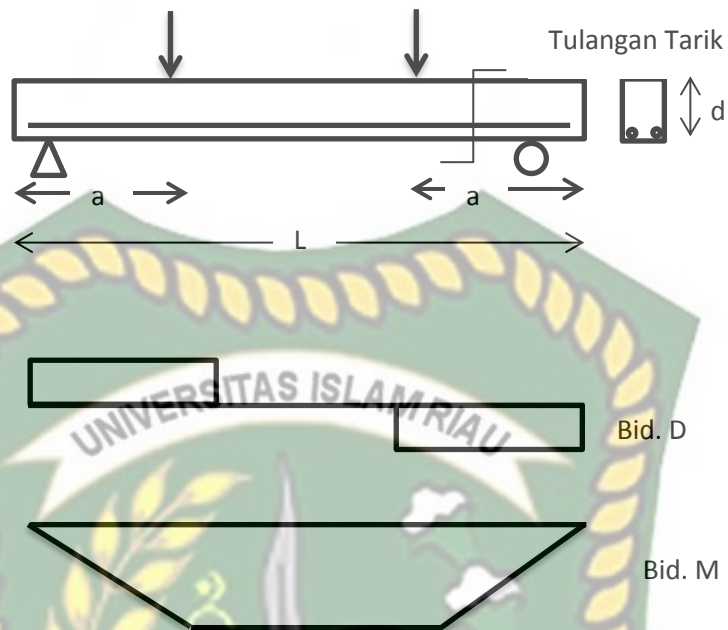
Elemen Balok Beton Bertulang (Nawy, 2008)
